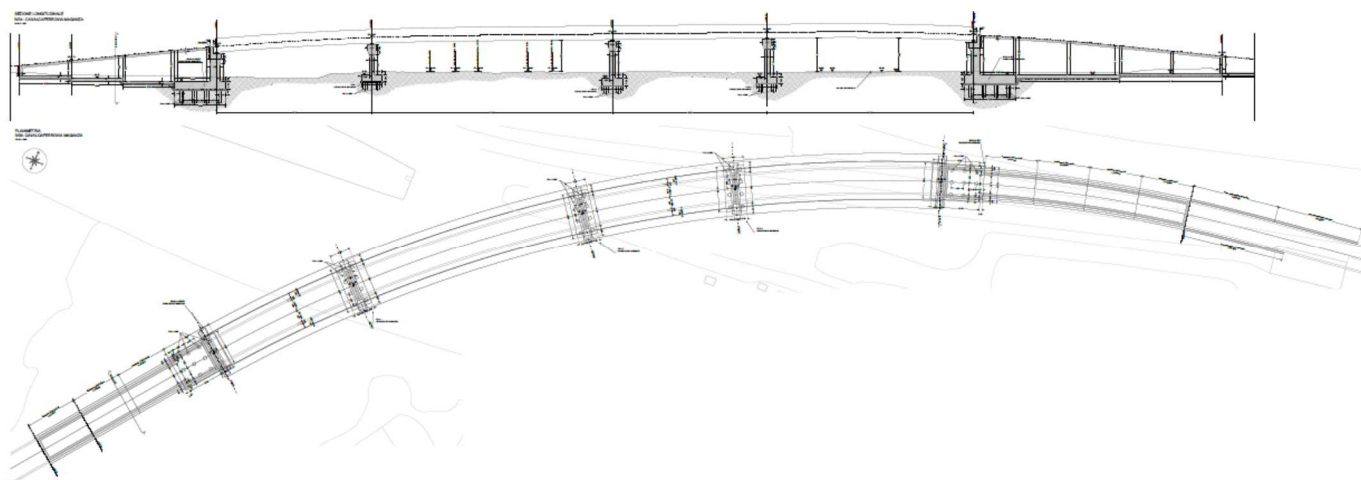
Planimetria e Profilo del Cavalcaferrovia Maganza
